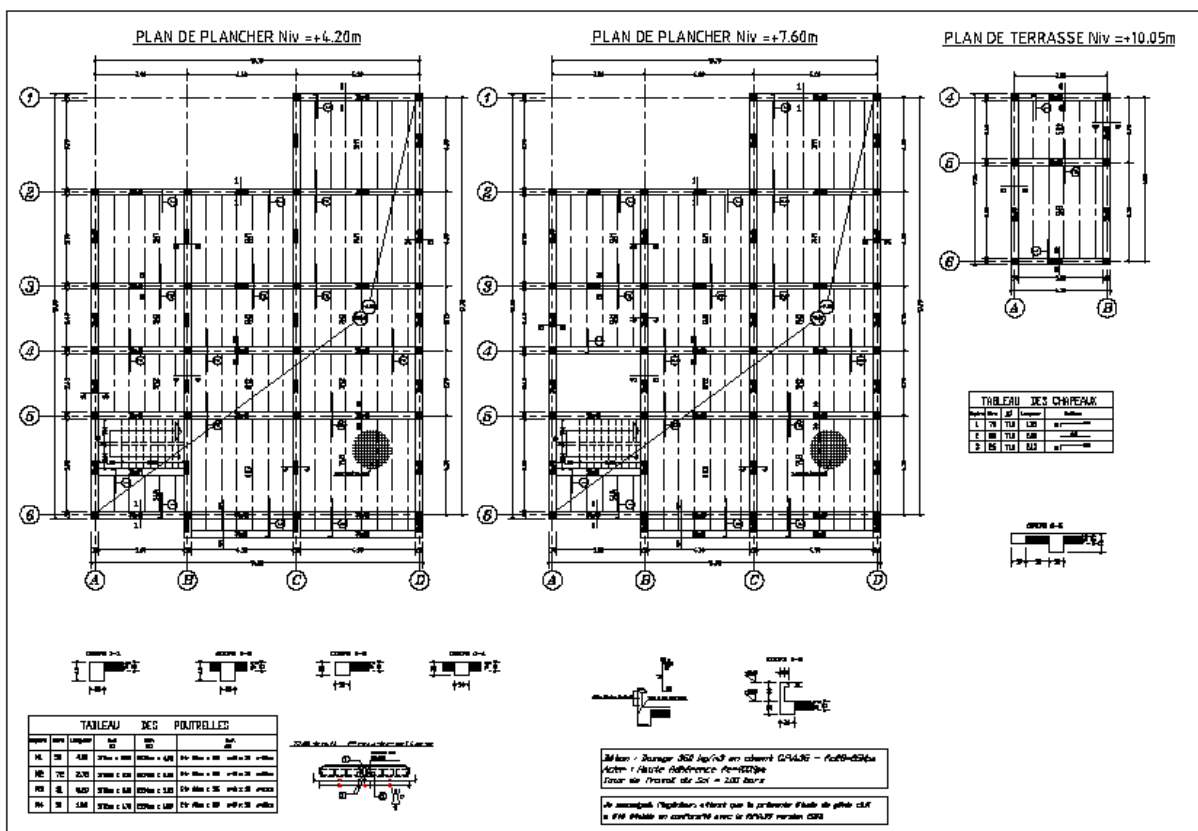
Plan de plancher Niv = +4.20m, +7.60m, +10.05m
